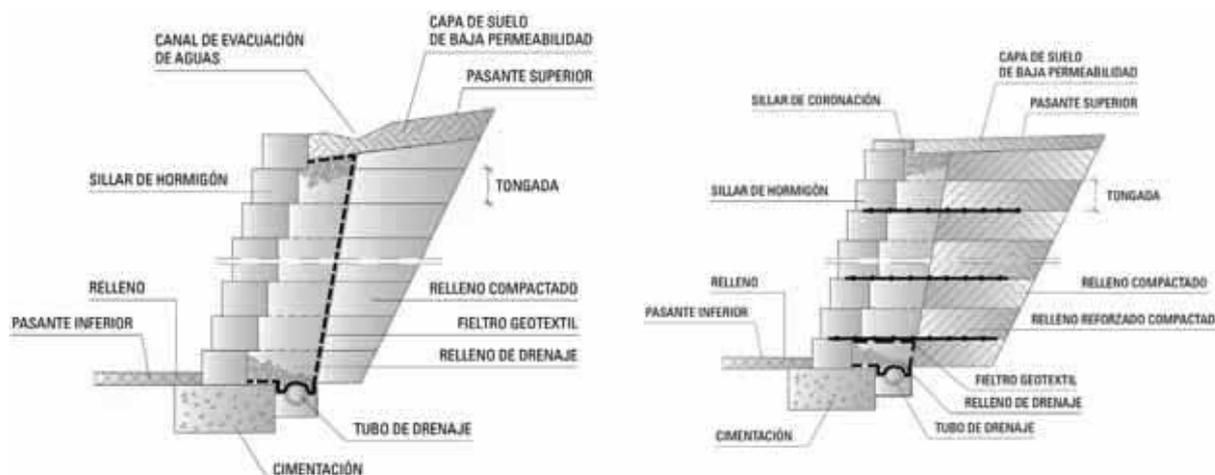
Muros de contención de tierras. Muro sin refuerzo [izquierda] y muro con refuerzo interior de malla sintética [derecha].
